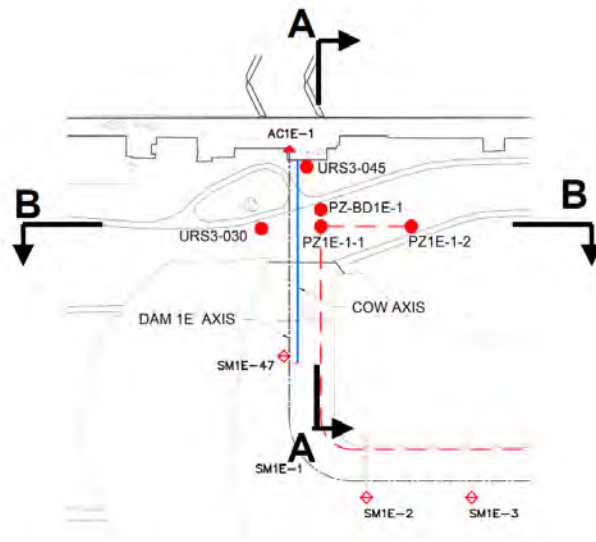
Ubicación de piezómetros cerca del muro norte de pilotes secantes
